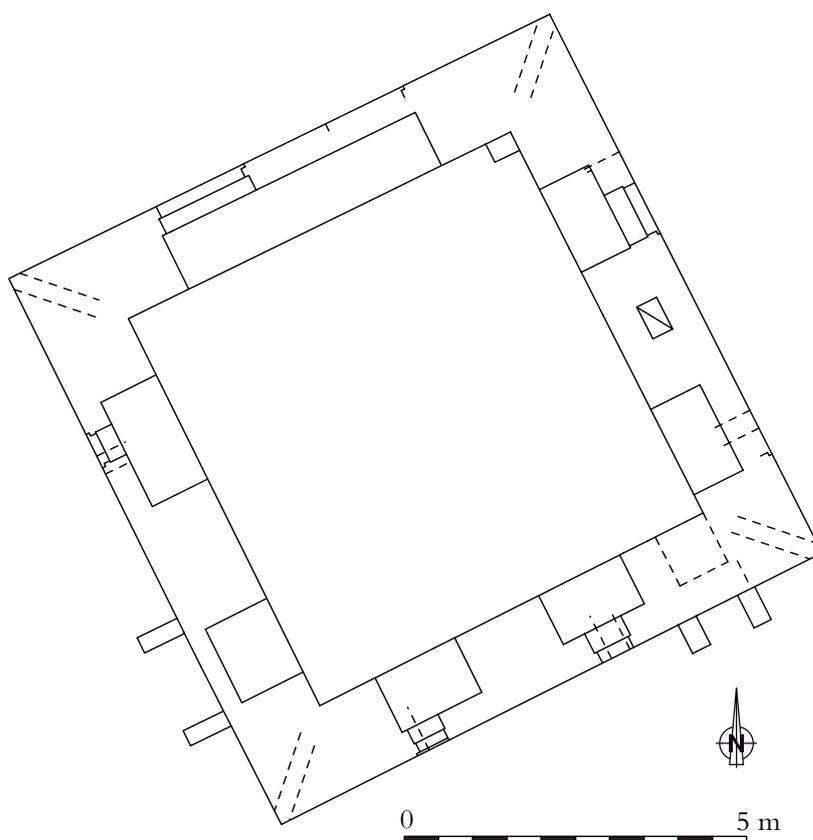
plan du dernier niveau de la tour. (J. V., G. A., Guy Charleux)
